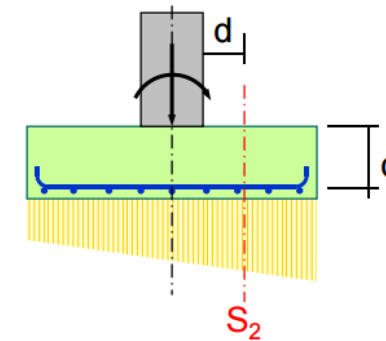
Corte en la Sección 2. Fuente: Apuntes de la asignatura de Estructuras de Cimentación y Contención Armado.
